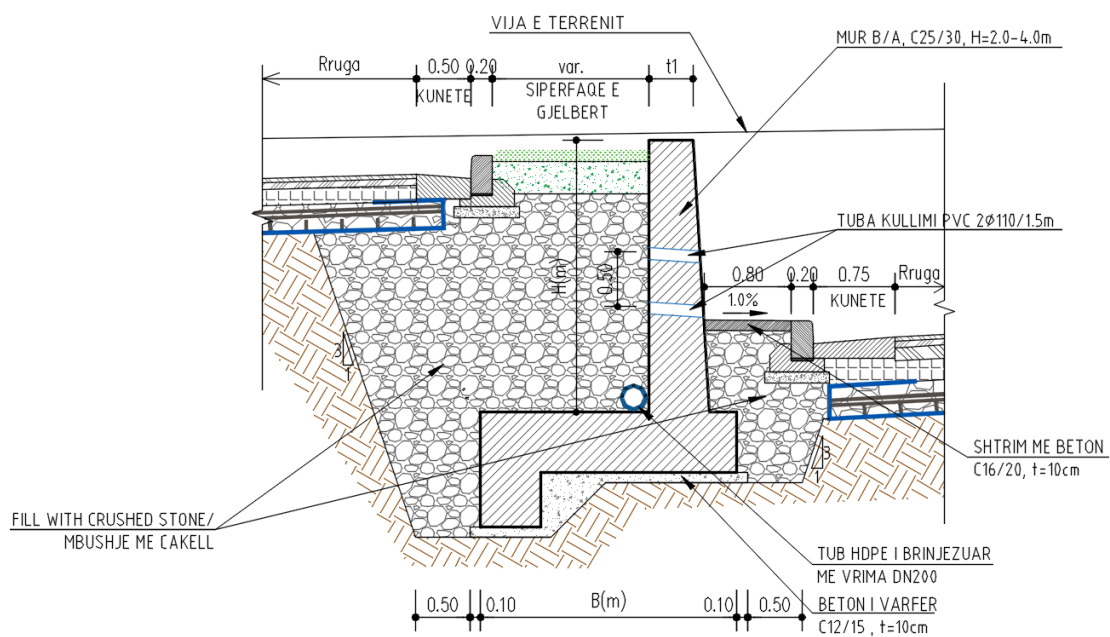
Seksion Terthor Tip me Mure Beton-arme
